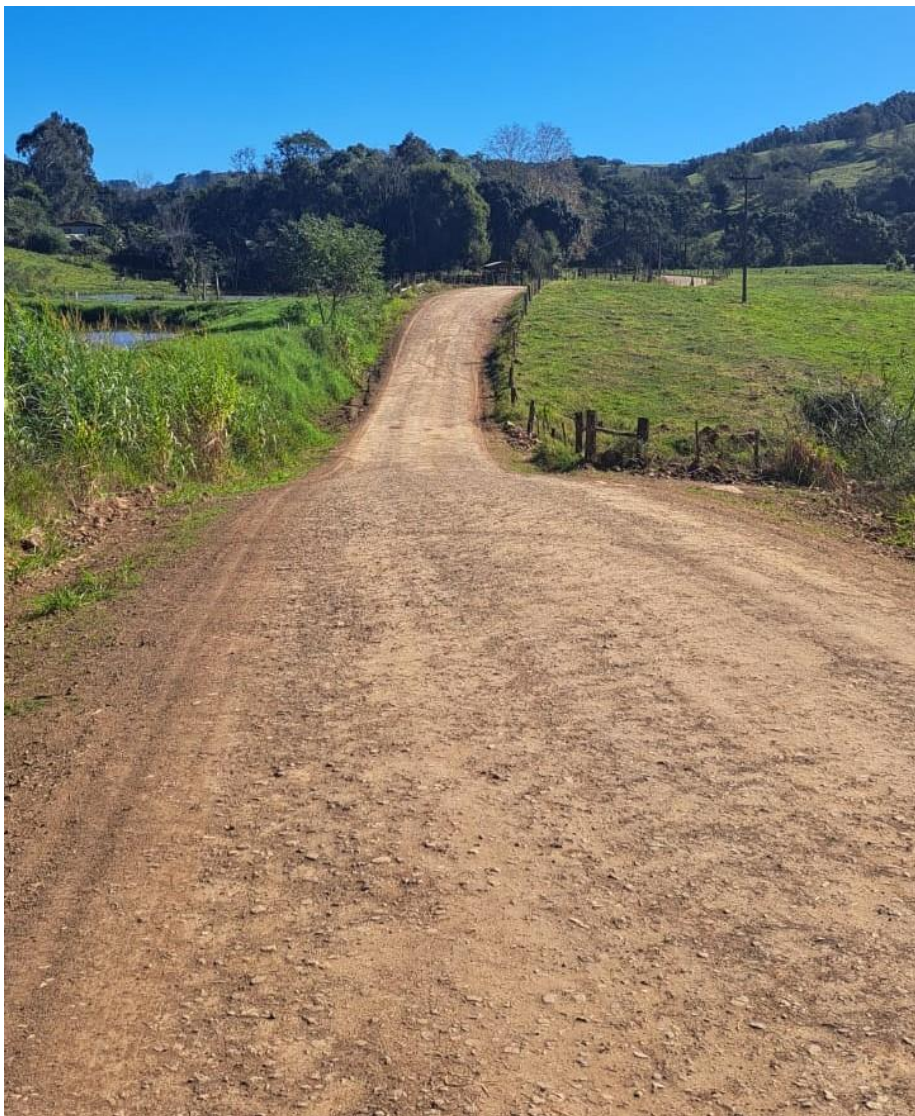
Trecho da estrada EMS-020 a ser pavimentado (região da Estaca E37-E38 – 26°38'05.1"S 52°41'46.7"W).
